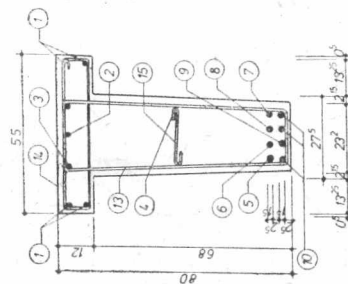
a. Armarea unei grinzi de rulare din beton armat. Secțiune longitudinală (proiect I.P.C.T.).
